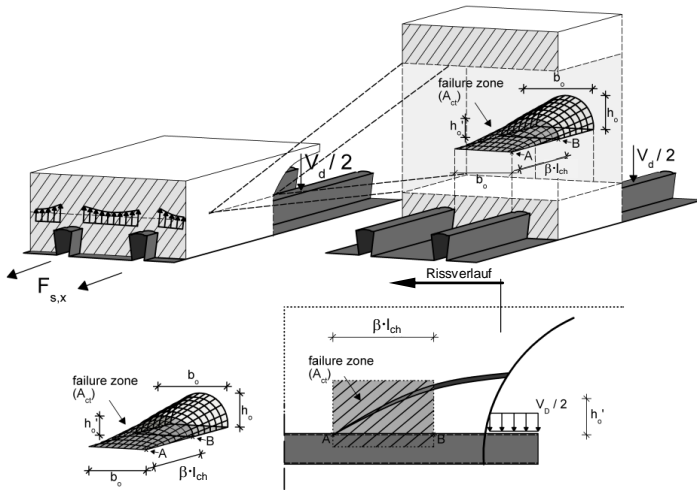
Idealisierte Form des Betonbruchbildes, inklusive dessen Lokalisierung am Übergang zum maßgebenden Biegeschubriss.
